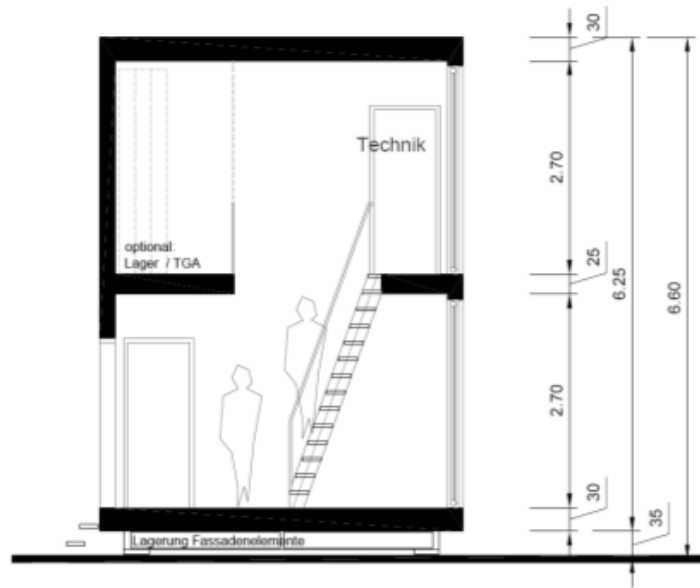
Schnitt A-A durch den zweigeschossigen Fassadenprüfstand
